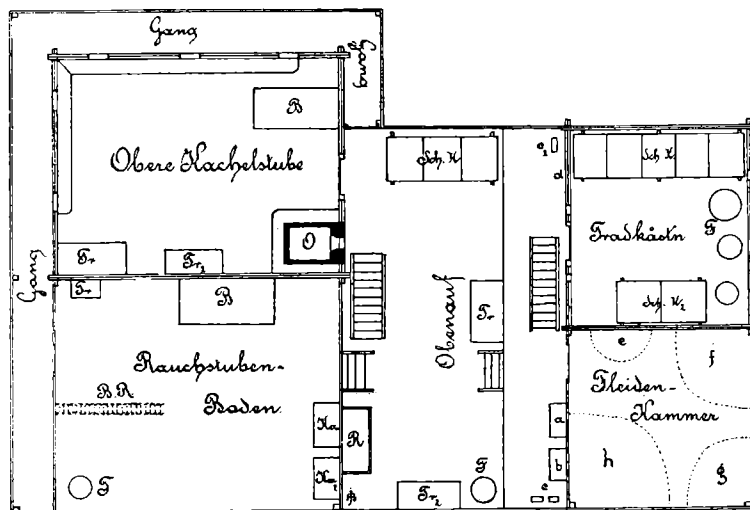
Grundriss des Obergeschosses des Winkler-Hauses.
